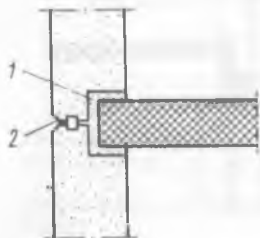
Соединение между несущей наружной ячеистобетонной стеной и несущей внутренней бетонной стеной
